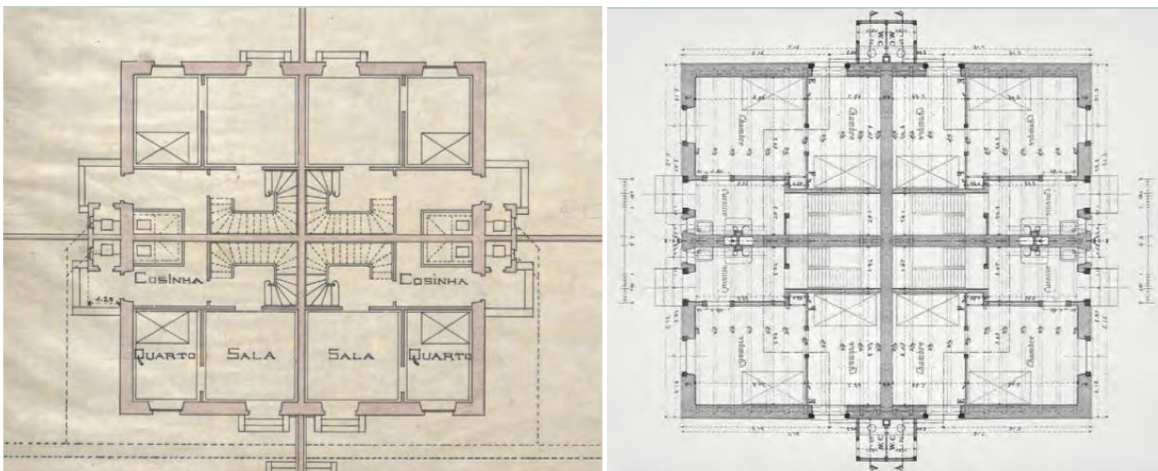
Planta térrea de um conjunto de quatro casas do Bairro Monte Pedral (extracto do primeiro desenho de 1899, de Marques da Silva, à esquerda); Émile Muller, Planta térrea do "type mulhosien" (planta composta por Eliseu Gonçalves a partir do desenho publicado em 1889 no livro *Les habitations Ouvrières en tous Pays*, à direita).
